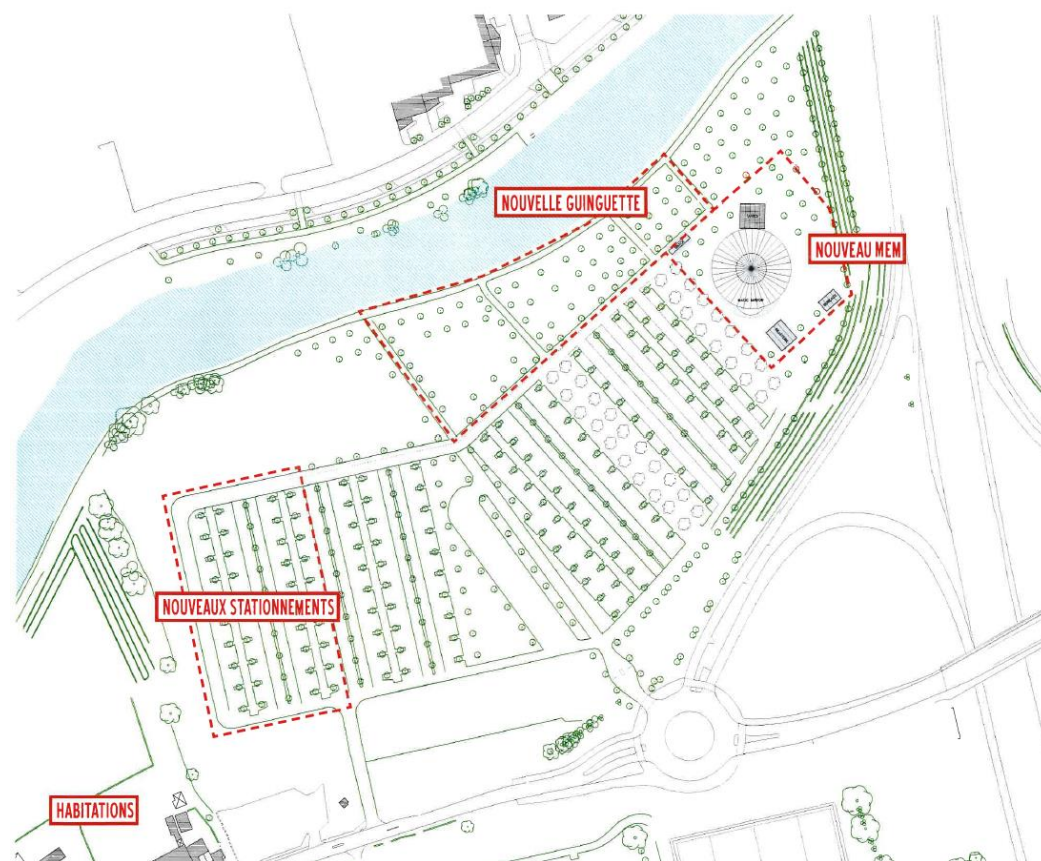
plan masse du scénario à l'est des parkings - source : Vivement Maintenant
